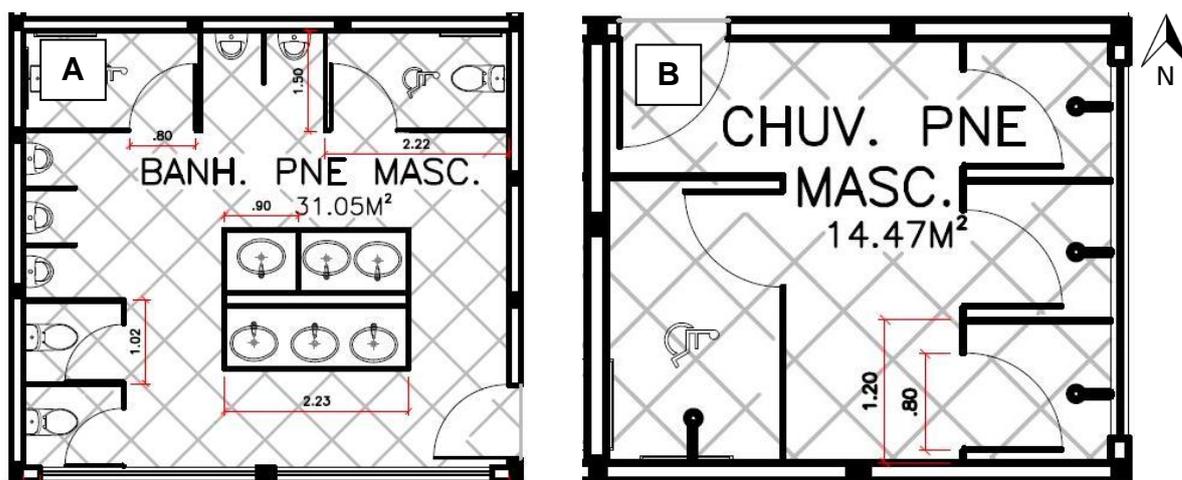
A) Planta baixa do banheiro – Prancha 3/5. B) Planta baixa da área de banho – Prancha 3/5. Fonte: Elaborada pela autora, 2018.
